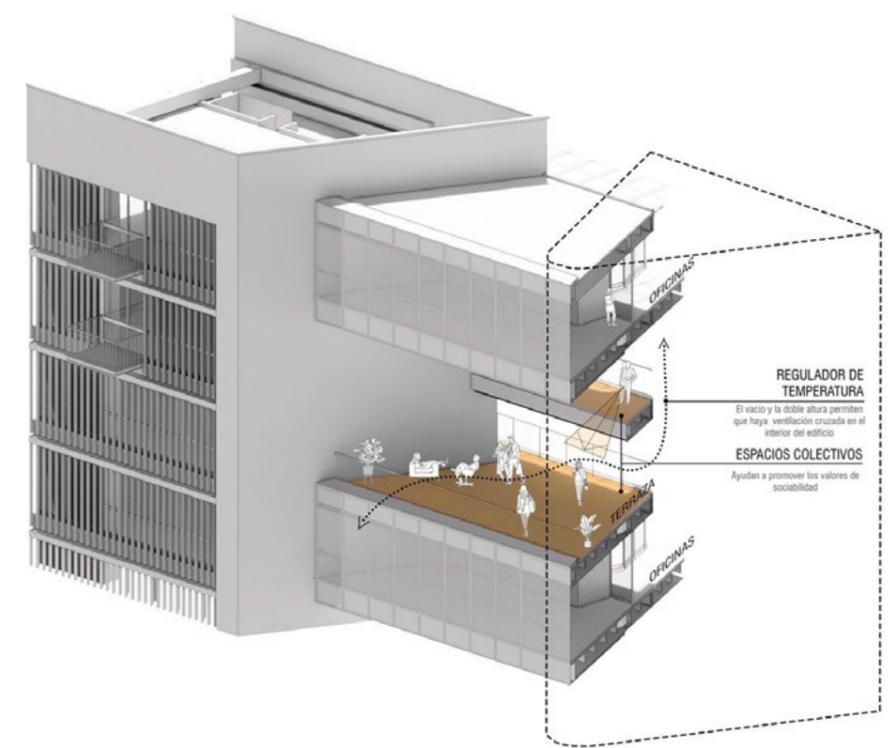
Diagrama isométrico de fachada Brise Soleil - Terrazas de uso colectivo. Fuente: Obranegra Arquitectos.
